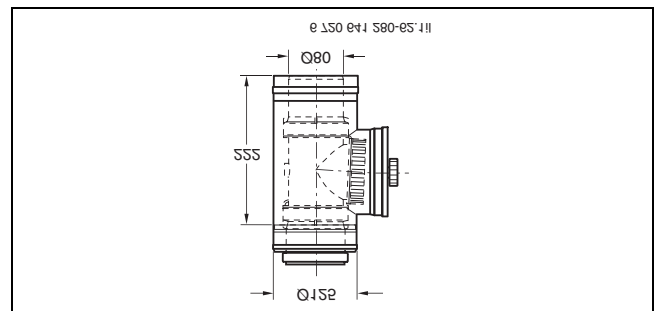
Konzentrisches Rohr mit Prüföffnung (Maße in mm)
